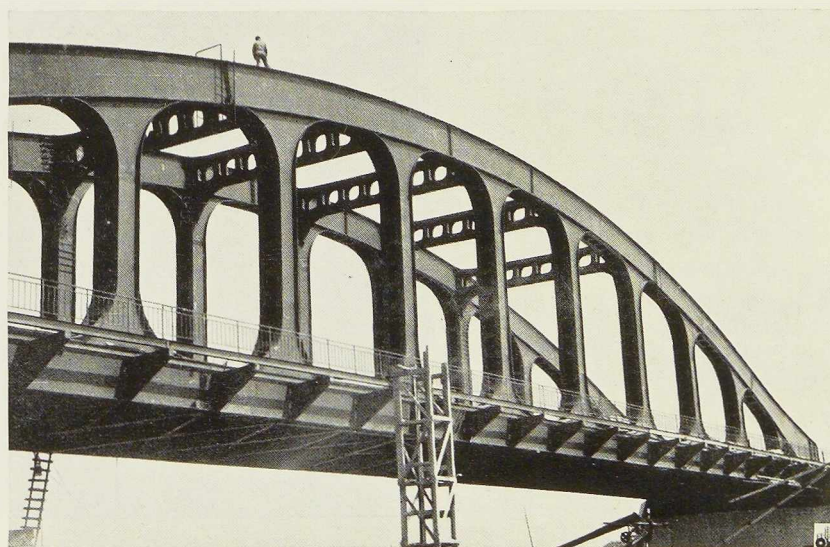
Le contreventement supérieur est assuré par des poutres du type Vierendeel en caisson. L'ouvrier debout sur la membrure supérieure donne une idée des importantes dimensions de cet ouvrage.
